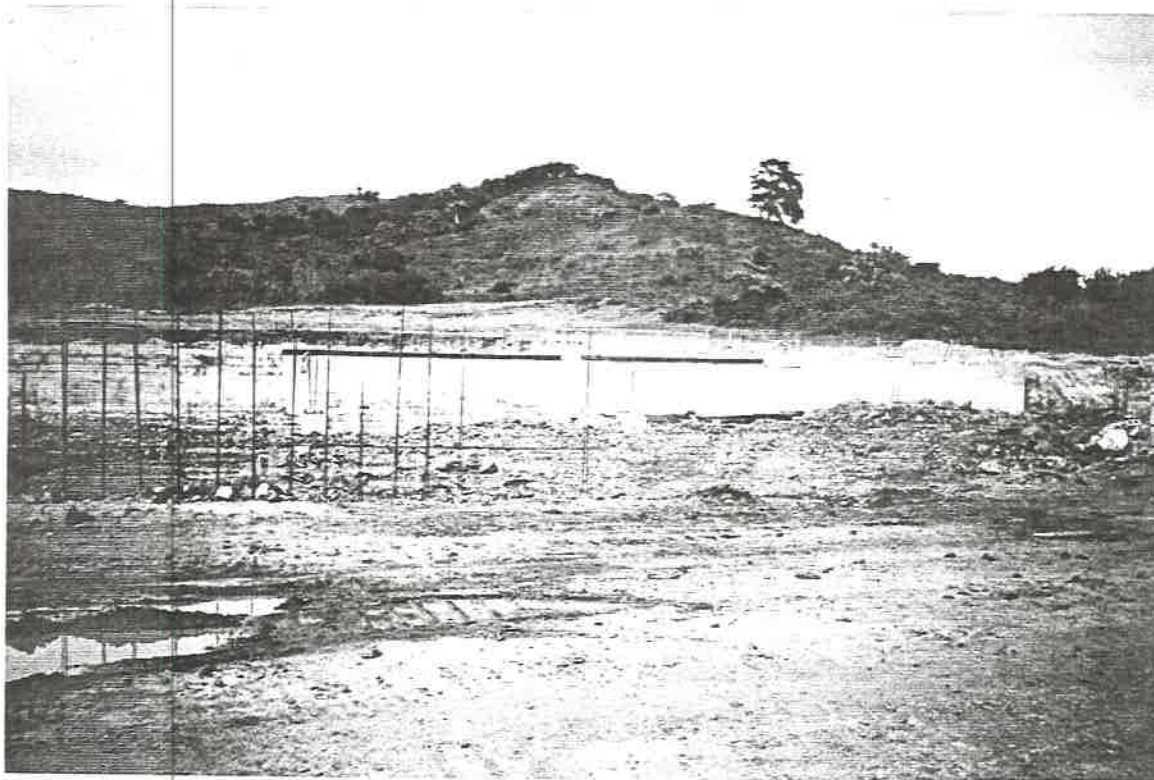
Muro de contención de concreto reforzado y varillas de acero colocadas de las fundaciones del edificio de palcos preferenciales, graderías, suites,etc.
